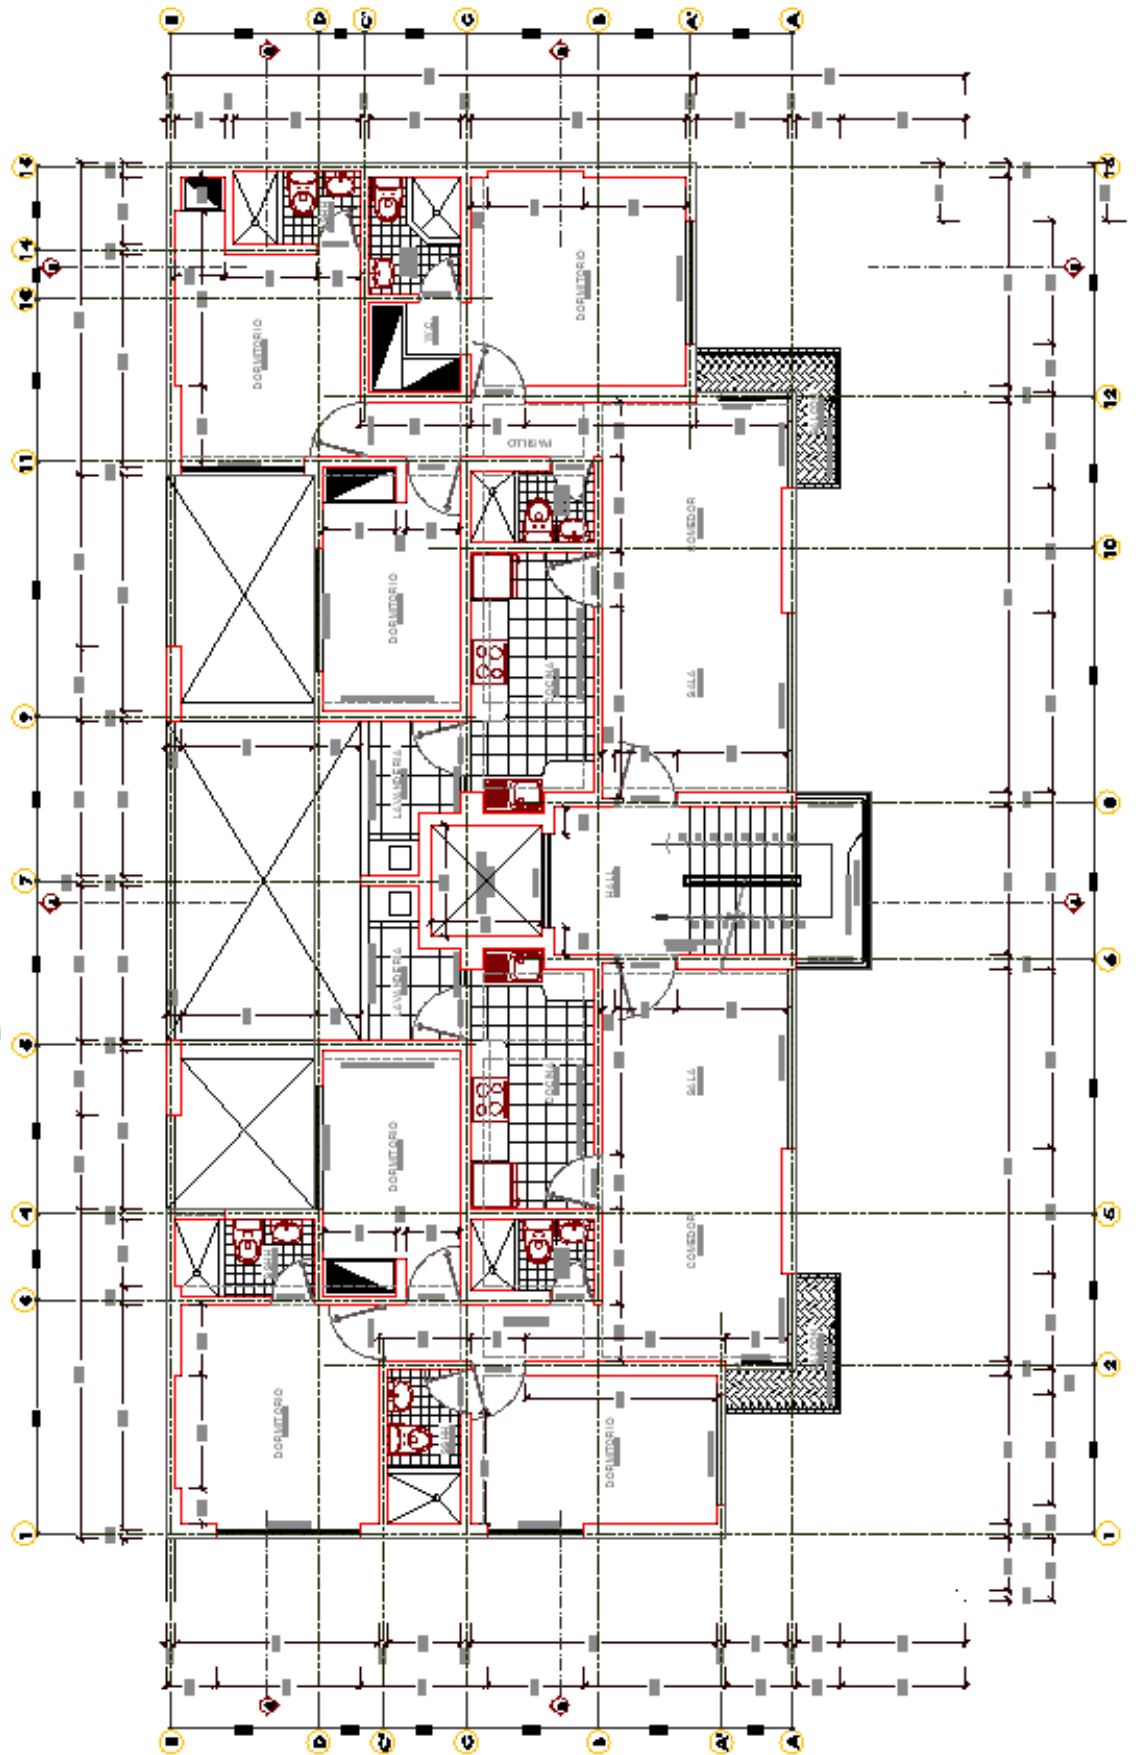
Arquitectura planta típica 2do a 5to Piso.
